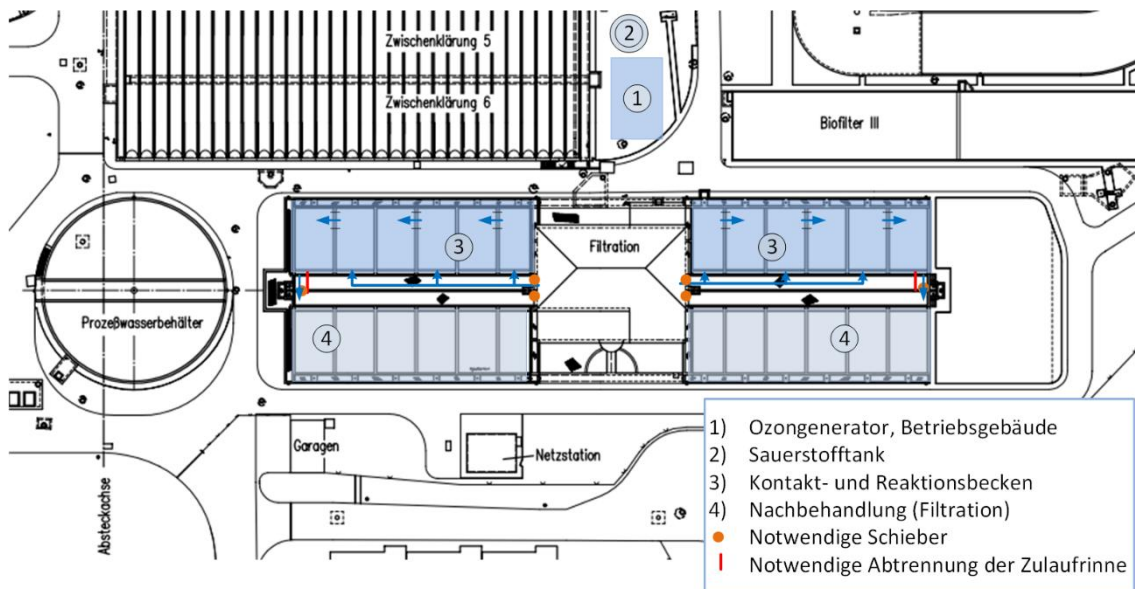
Lageplan der Variante 1 auf dem Klärwerk Krefeld
